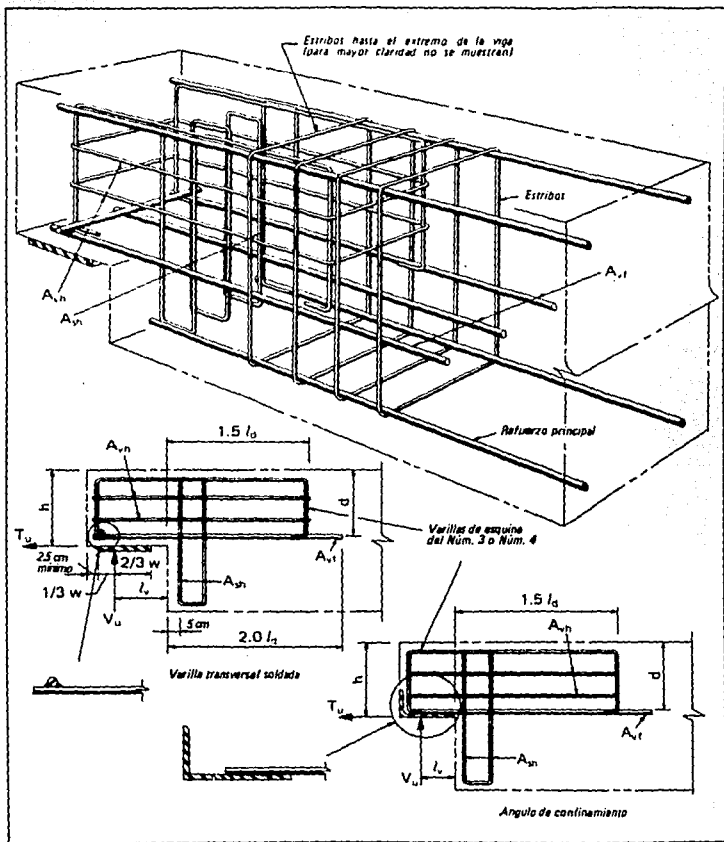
REFUERZO PARA VIGAS DE EXTREMO
